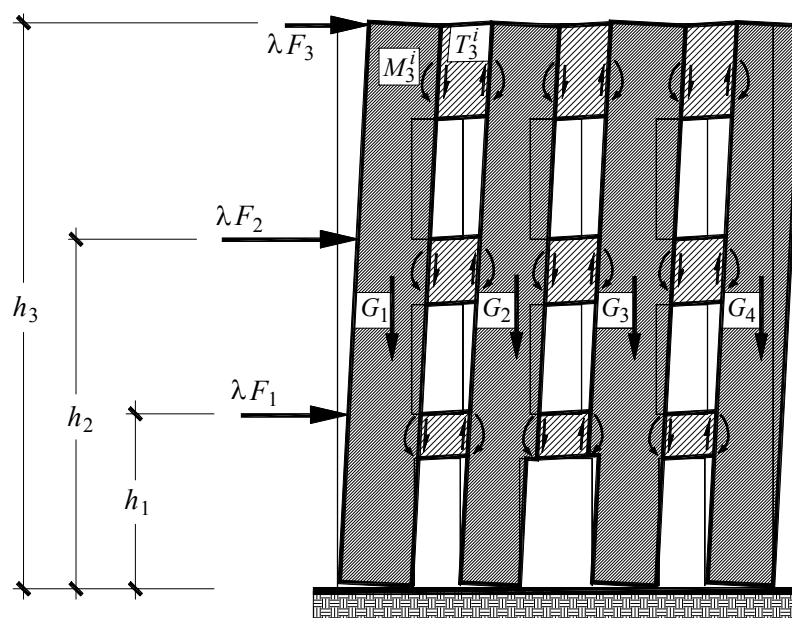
Meccanismo di collasso di una parete regolare in muratura per rottura delle fasce.
